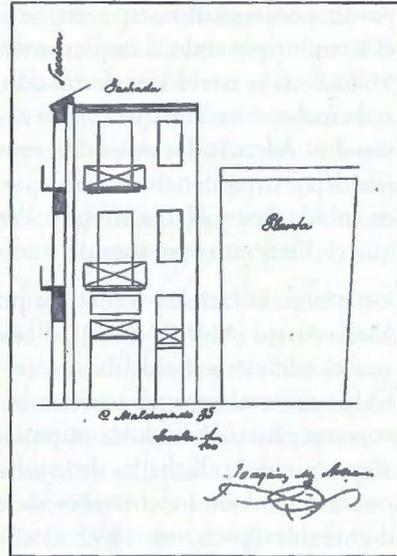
Plano de proyecto de demolición y nueva construcción de la fachada redactado por el arquitecto Joaquín María Arnau en 1899 (AHMV, 1899).
